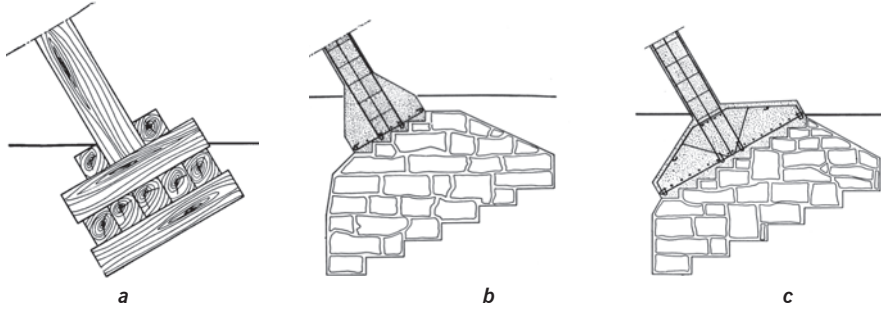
Pé de escora toda em madeira (a) ou de concreto armado, com base de pedra bruta (b,c)
